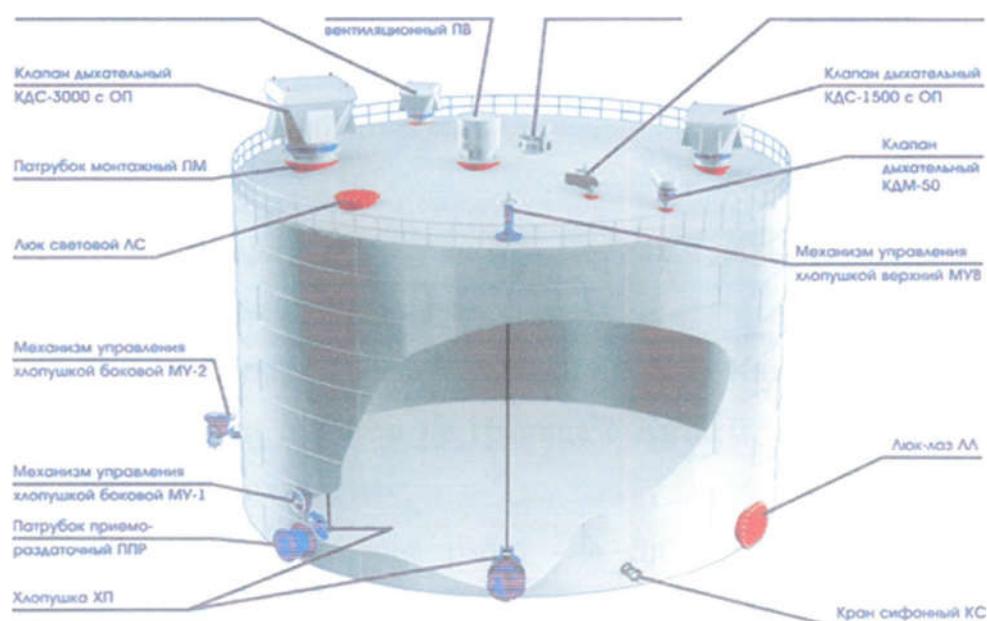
Схема вертикального стального резервуара с конструктивными элементами
